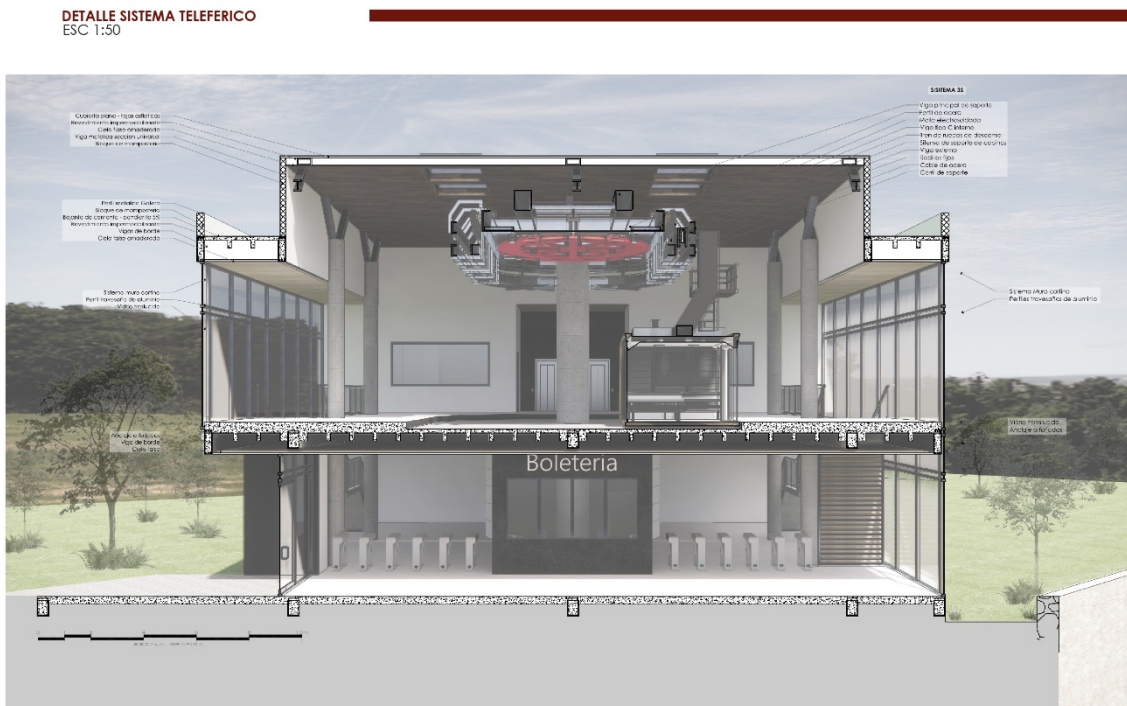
Detalle constructivo - corte por fachada (Elemento Propio)
